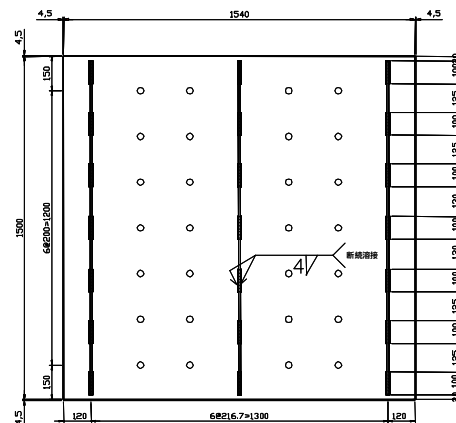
実験供試体（ロビンソン型鋼・コンクリート合成床版）
